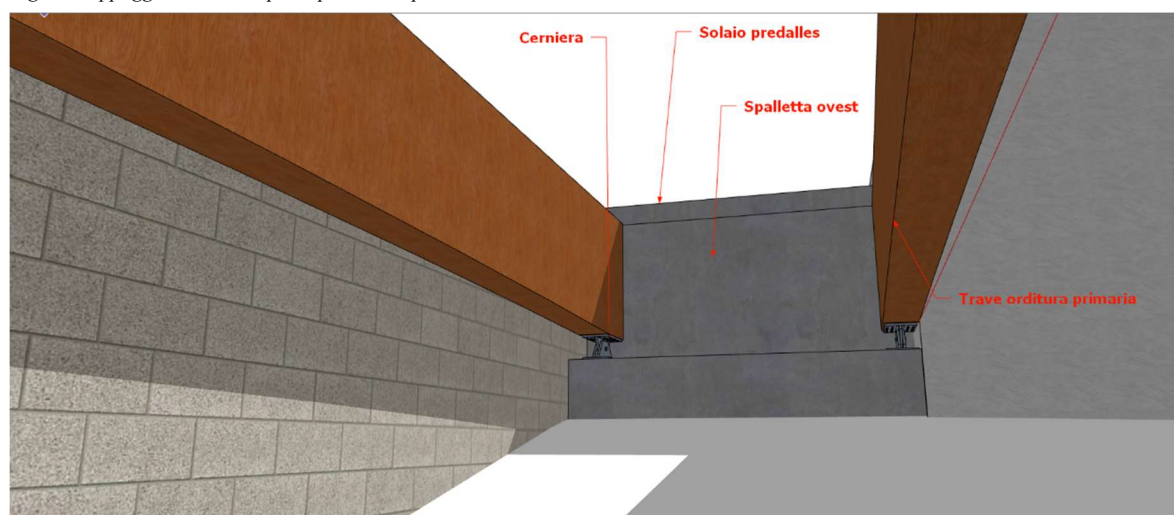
Appoggio delle travi principali sulla spalletta ovest su cerniere in acciaio
